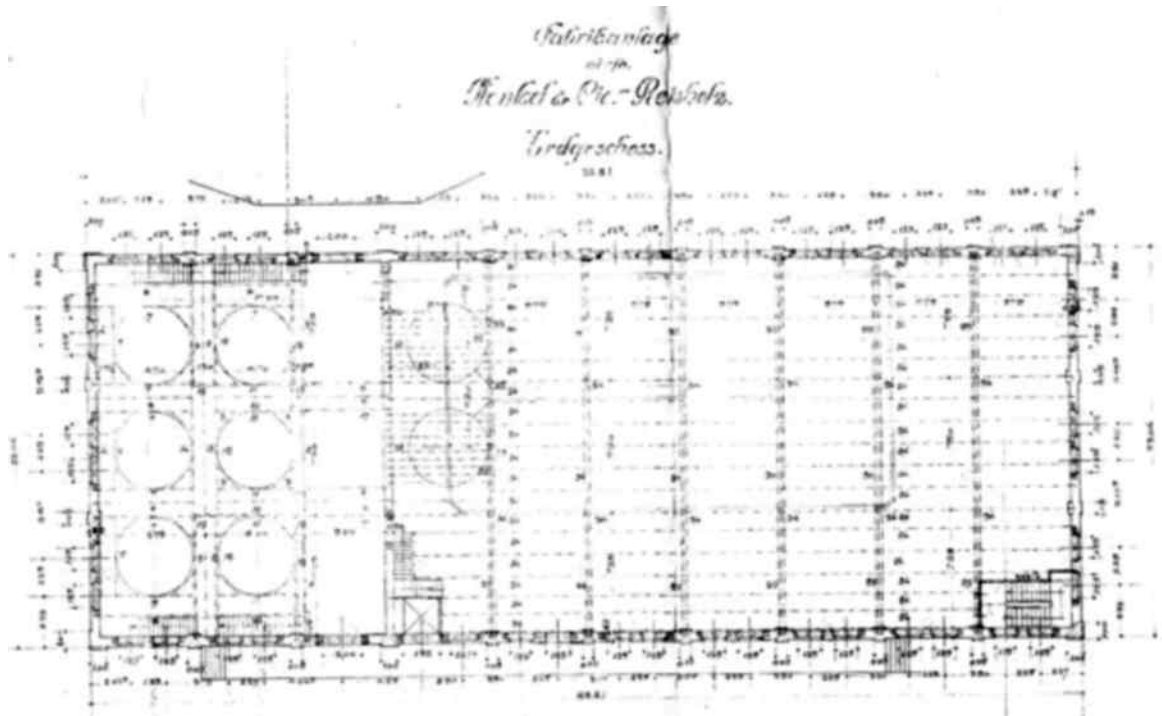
Neubau Seifenpulver-Fabrikgebäude Geb. C 02, 1911, Erdgeschoss - Architekt: Walter Furthmann
